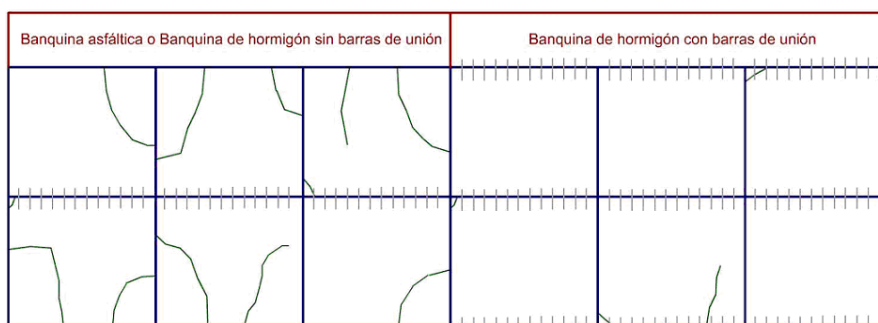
Caso 1 - Patrones de fisuración de pavimento con barras de unión en junta longitudinal.
